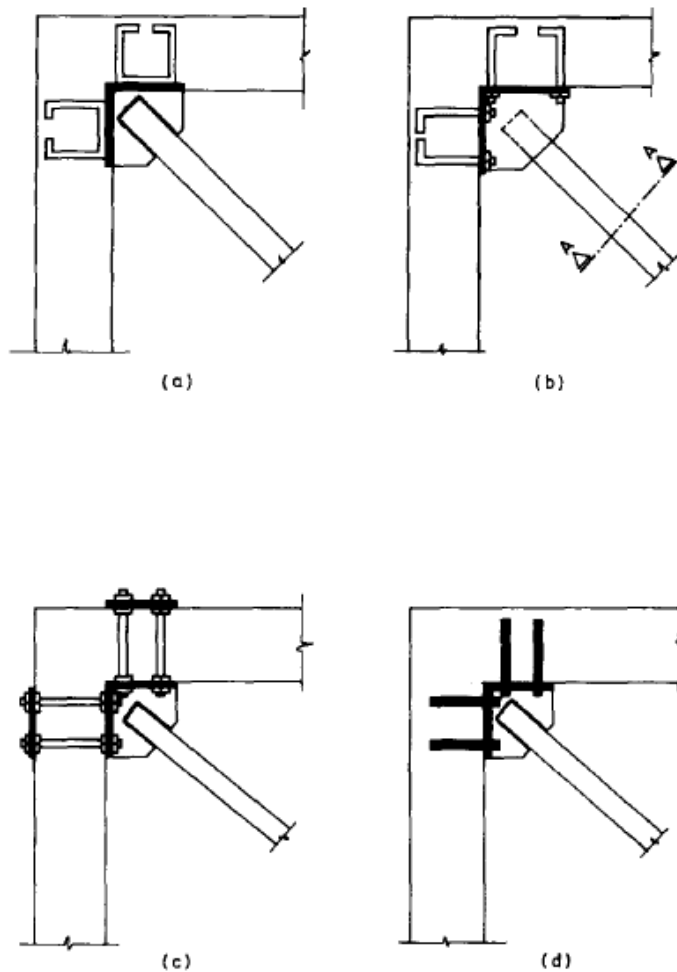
(a) e (b) sistemas de ligação para pórticos em construção; (c) e (d) sistemas de ligação para reforço de pórticos existentes [4].
